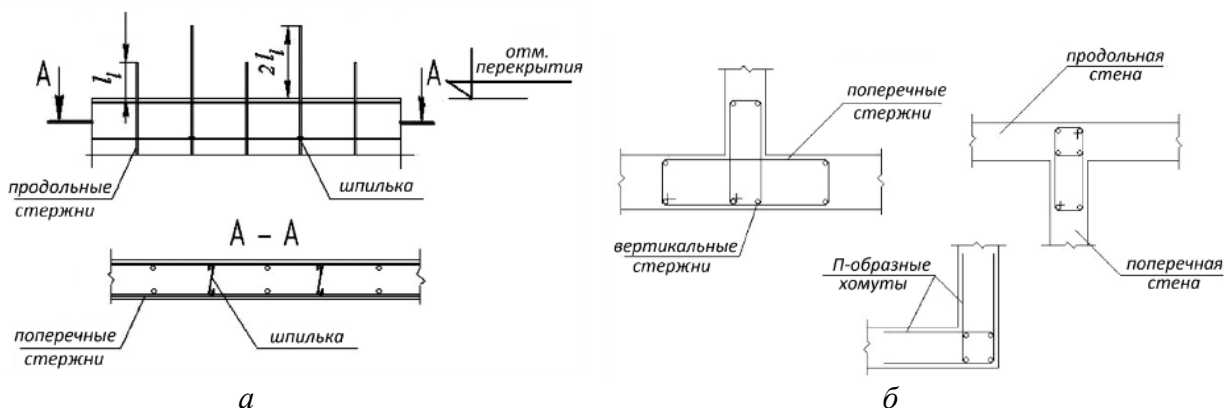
Схемы армирования несущих стен монолитных зданий:
